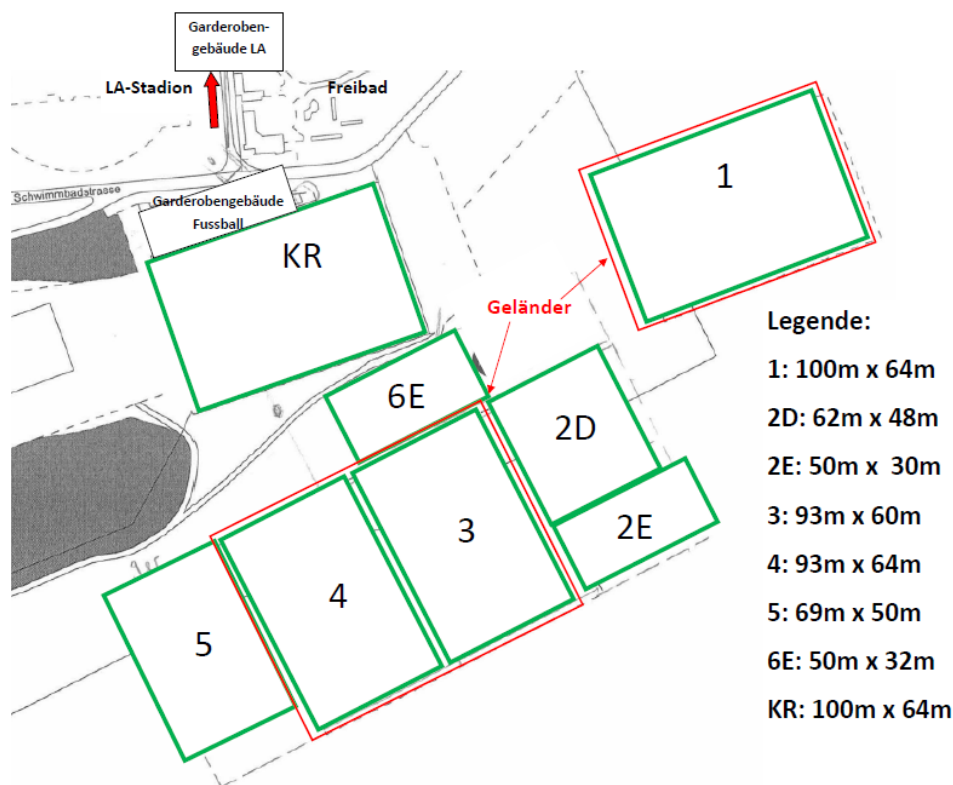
Plan Rasensportanlage Schachen Stand 2023
